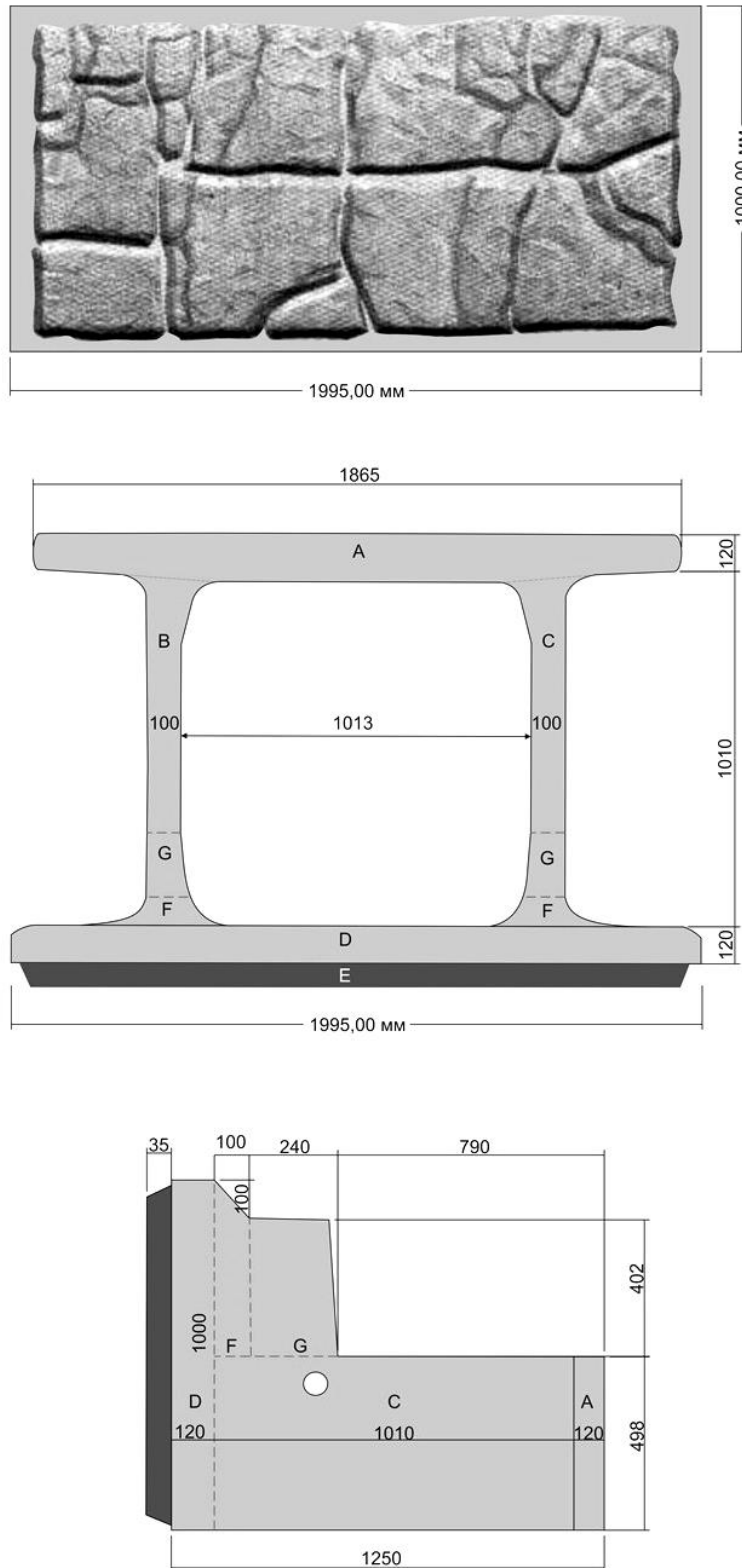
Блок конструктивный железобетонный КБП 100/200
